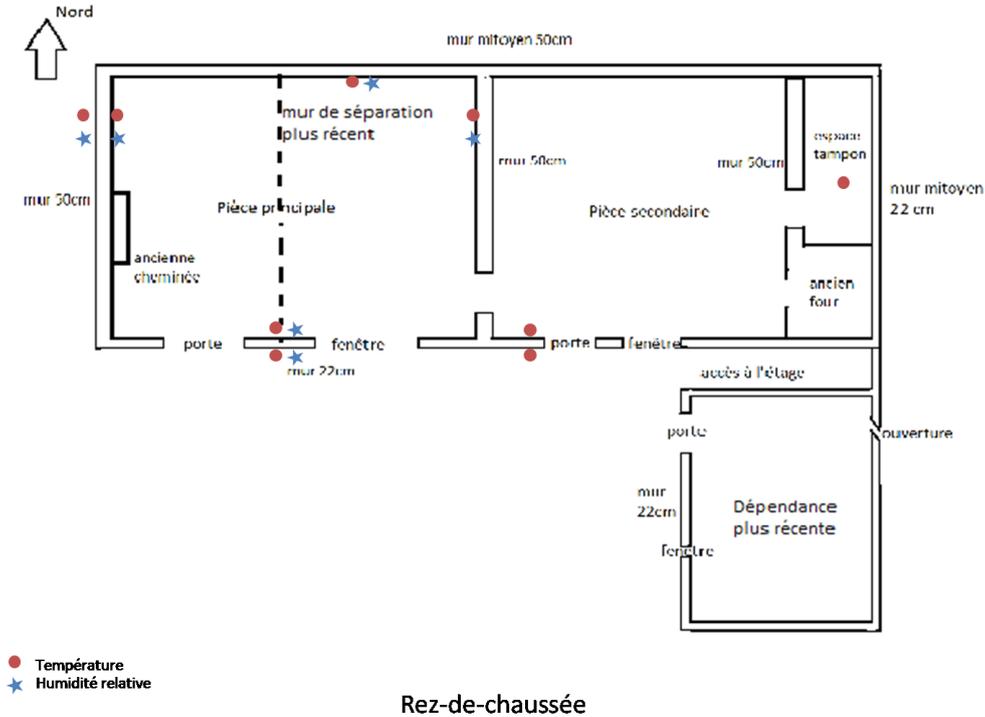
Plan de l'instrumentation du rez-de-chaussée
